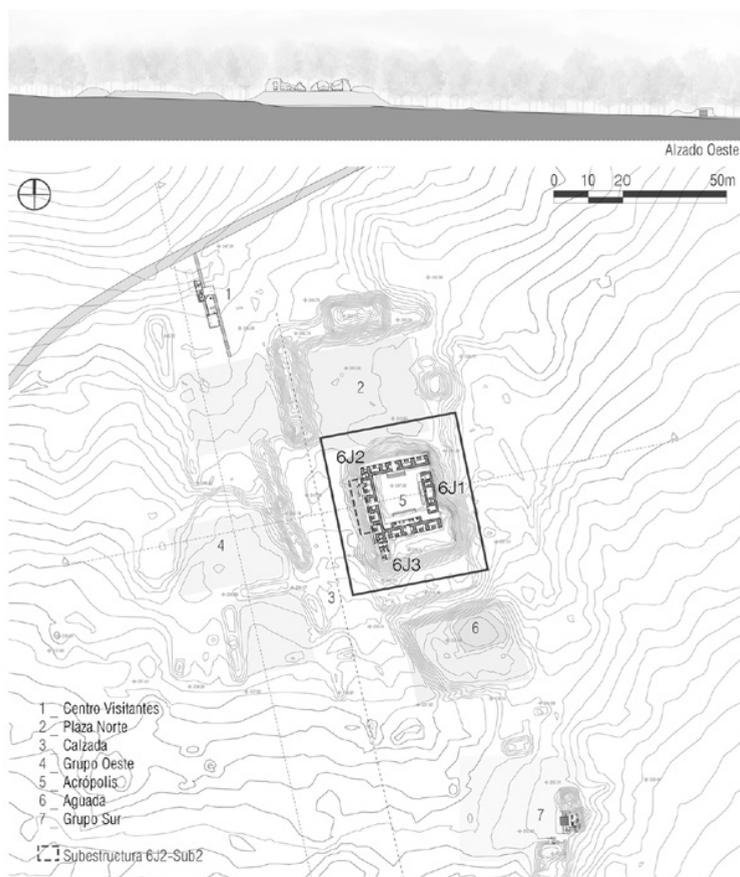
Planimetría y sección del sitio arqueológico de La Blanca. Elaboración propia a partir del plano topográfico del PLB.
